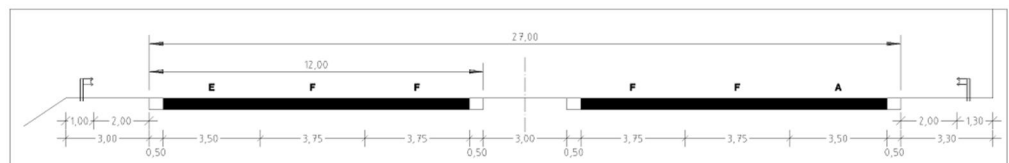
Querschnitt BAB A 281 mit Ein- und Ausfahrt und begrüntem Bankett (standfest ausgebildet)
